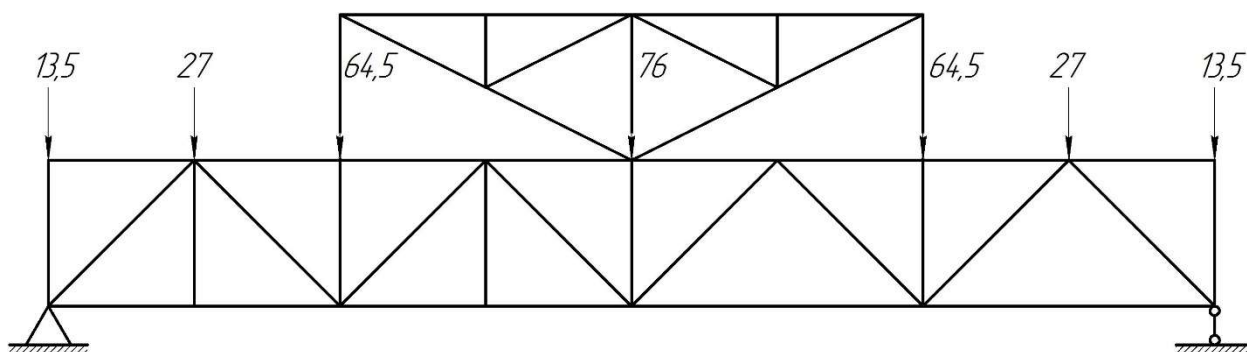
Схема загрузки фермы постоянной нагрузкой.
